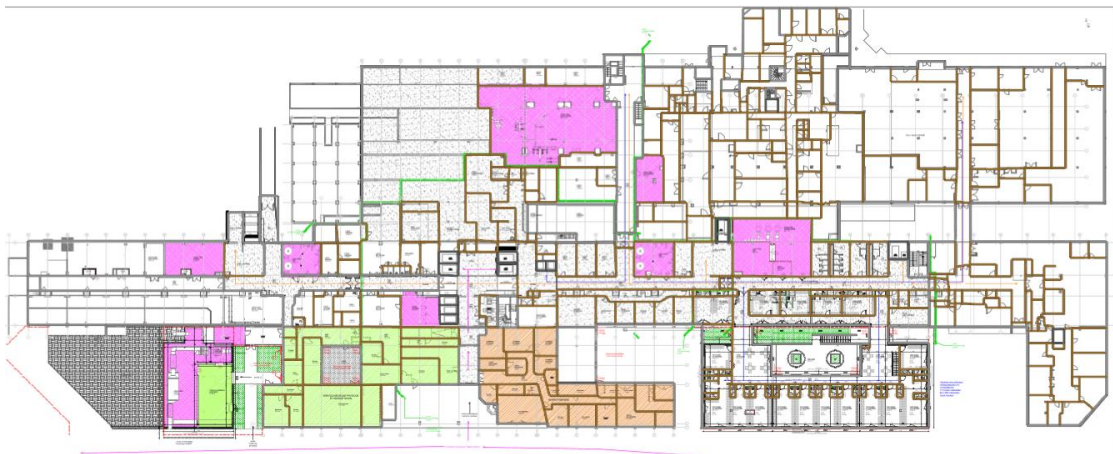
Plan du site avec les murs reproduit sur Ekahau
